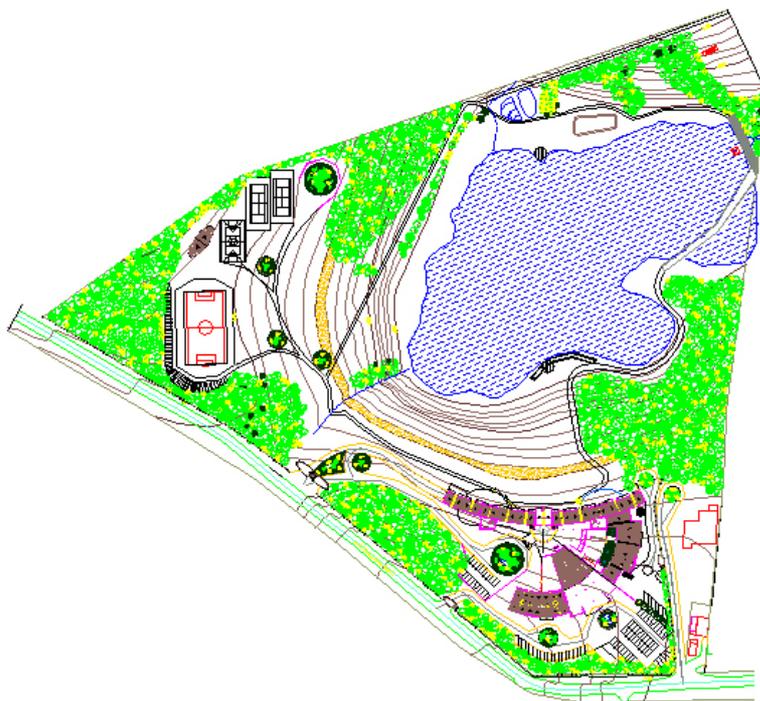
Planta Baixa Geral de Implantação, sem escala.
